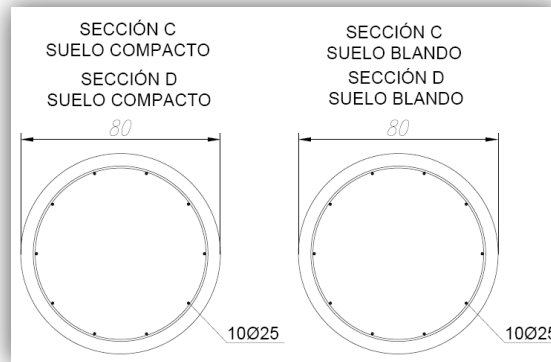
Detalle armadura longitudinal Pilote Ø0,80 m, sección C y D
